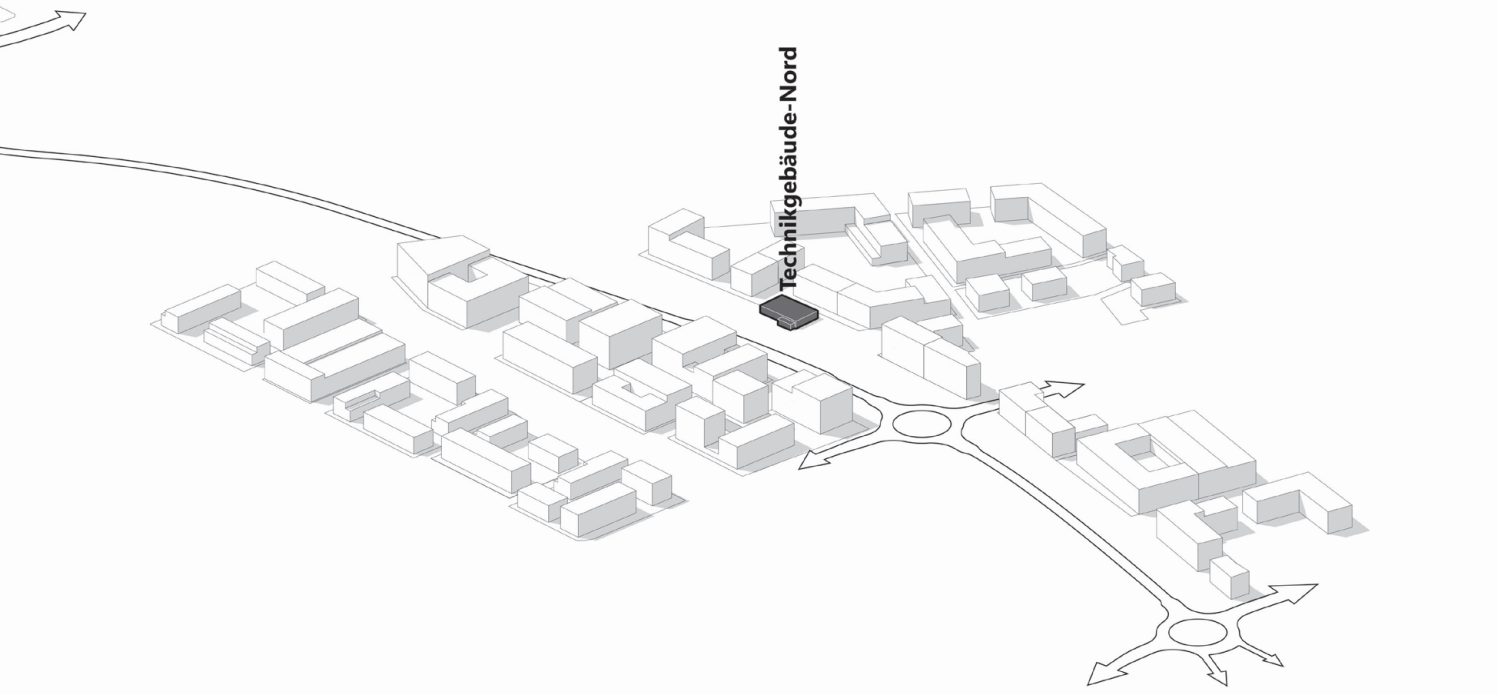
Hochwasserpumpanlage Schönhauser Straße, Köln
